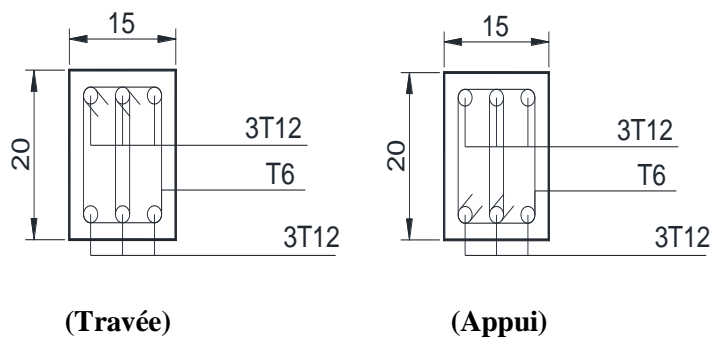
Ferrailage d'une poutre noyée secondaire 15x20cm (bâtiment R+10)
